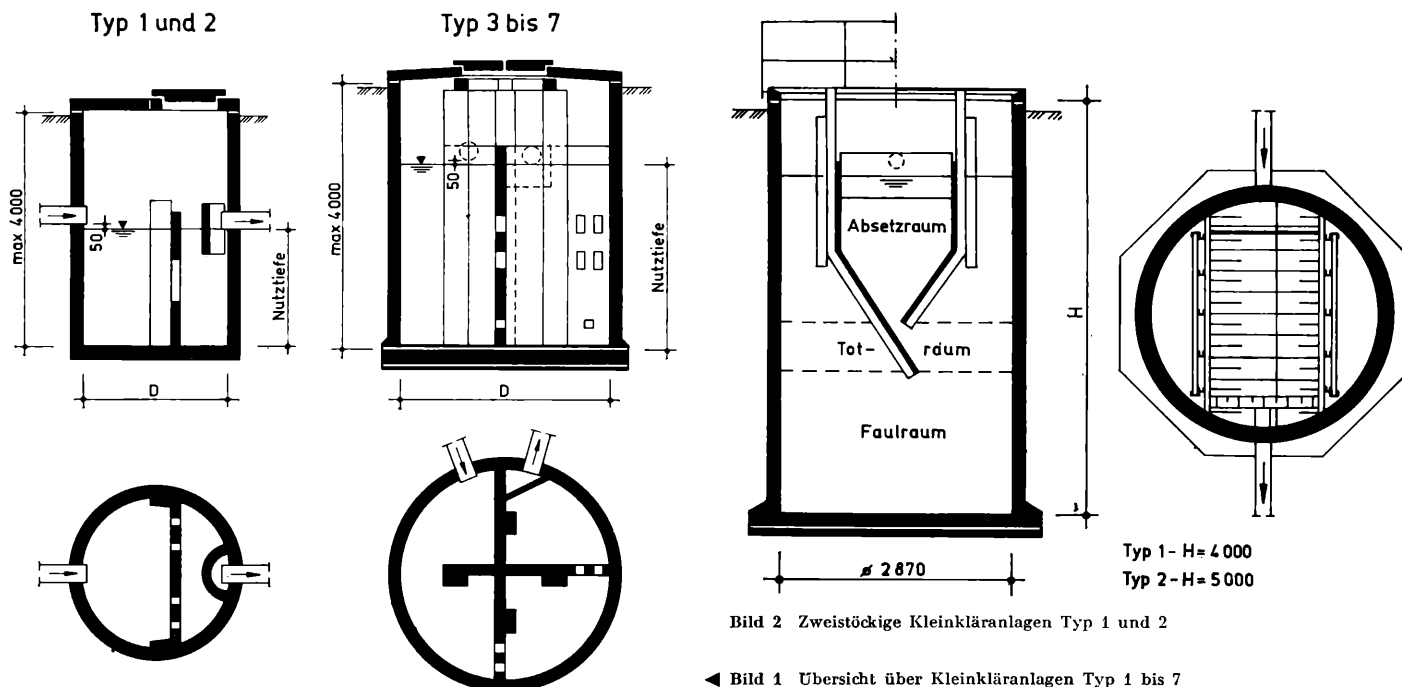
Zweistöckige Kleinkläranlagen Typ 1 und 2
